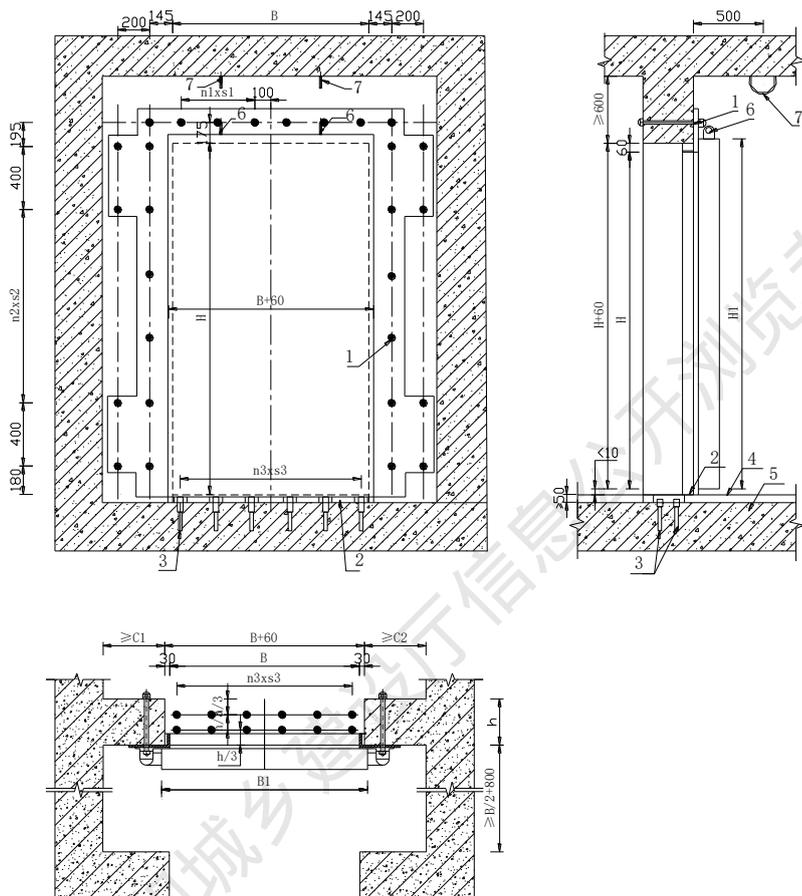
先浇筑混凝土后安装双扇防护密闭门
